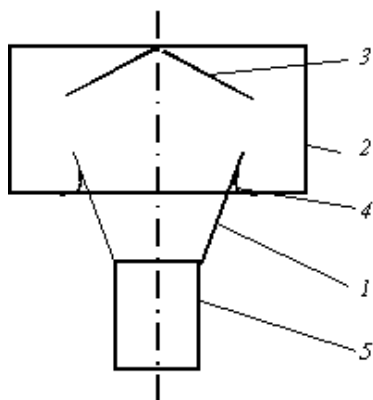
Дефлектор ЦАГИ: 1 - диффузор, 2 - цилиндрическая обечайка, 3 - колпак, 4 - конус, 5 – патрубок
